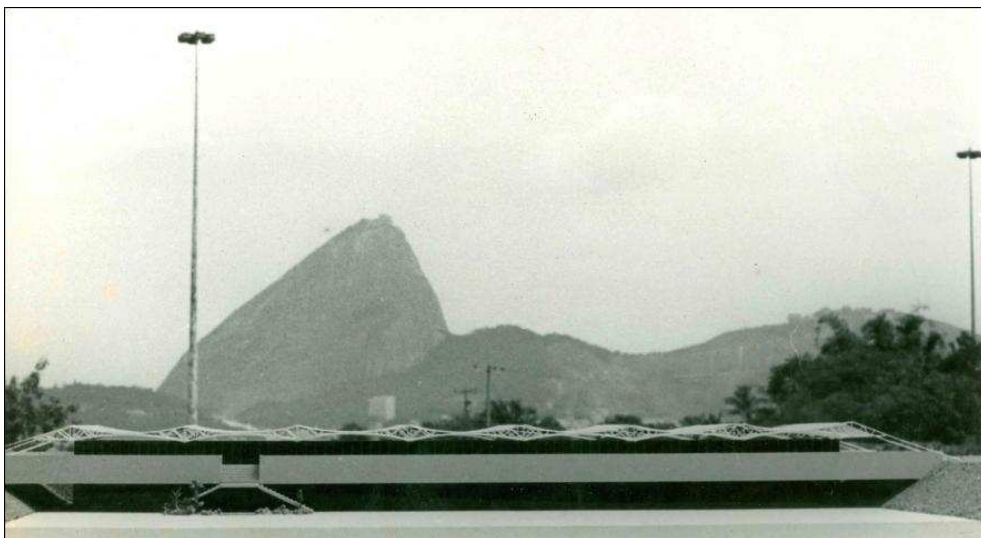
Maquete do projeto de modificação (Amaro Machado, Acervo do Autor)
